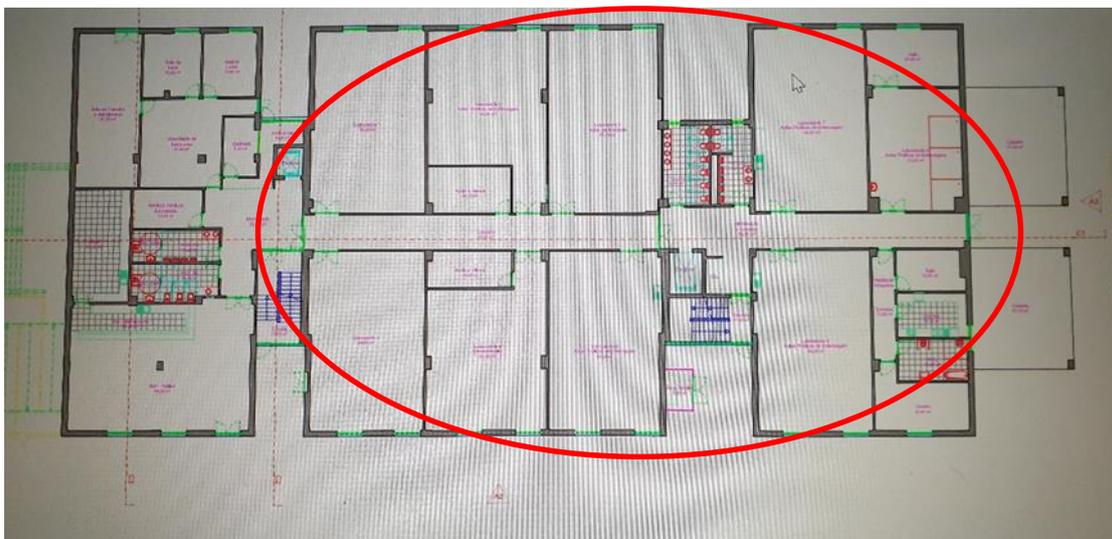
Planta do piso -1 com as áreas que irão sofrer obras de requalificação.
